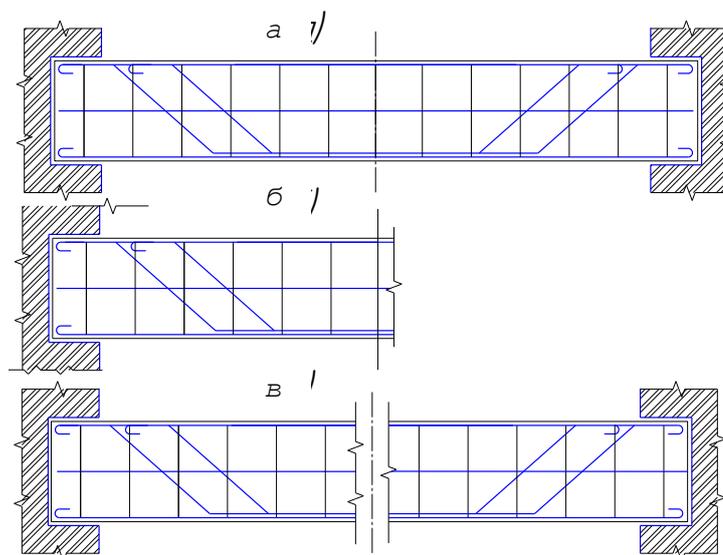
Определение формы изображения главного вида железобетонной балки
